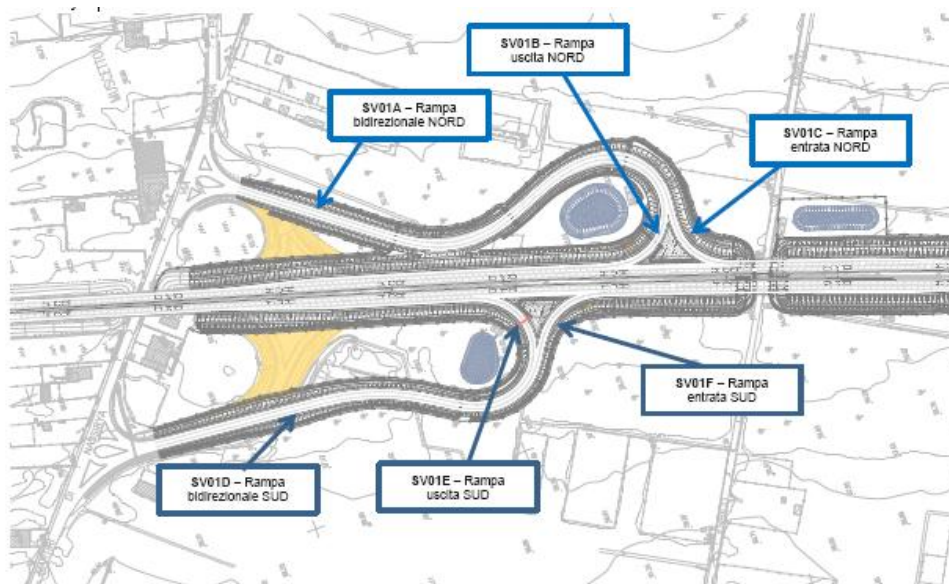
Stralcio Planimetrico dello Svincolo di Via Nuovo Poggiomarino
